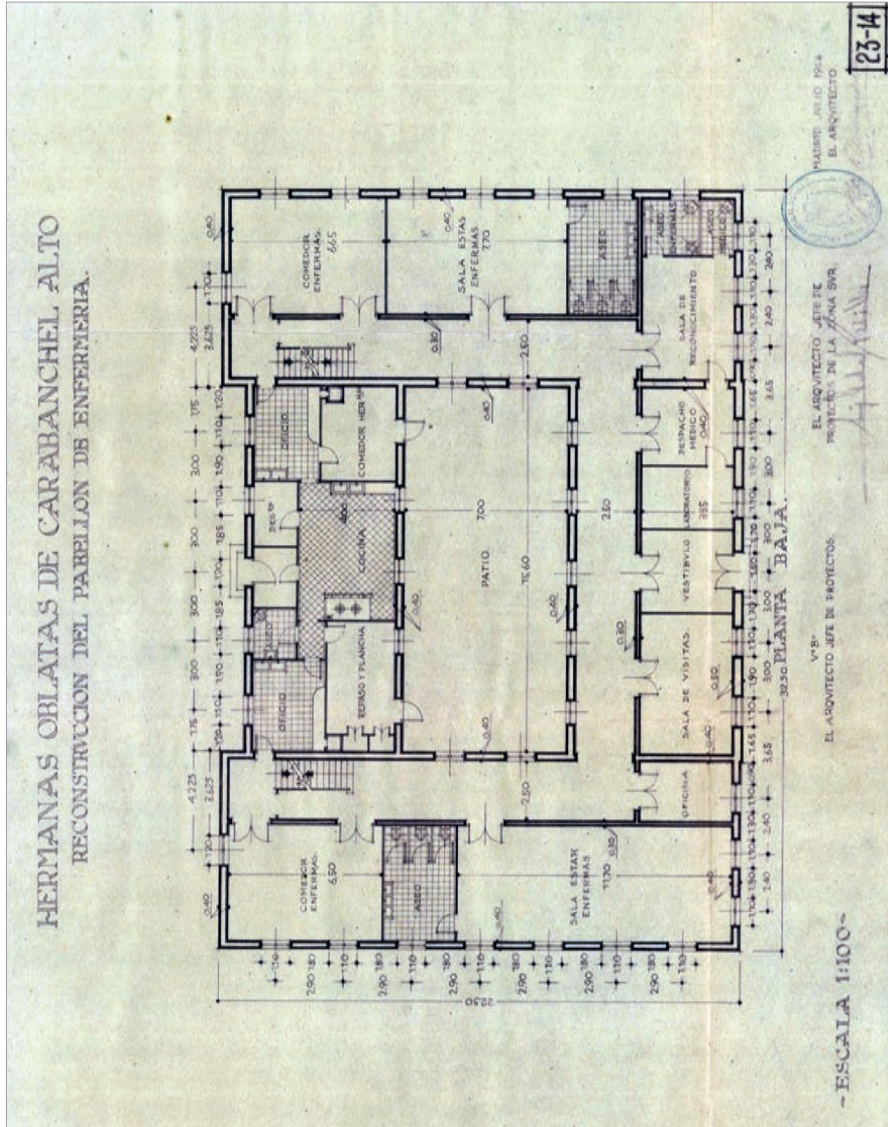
Pabellón de Enfermería del Convento de las Oblatas. Carabanchel Alto. Plano de planta baja, 1944. AGA, FAD 26/16195, carpeta n.º 55; (2) 81.03 2582 Top 76/04.
